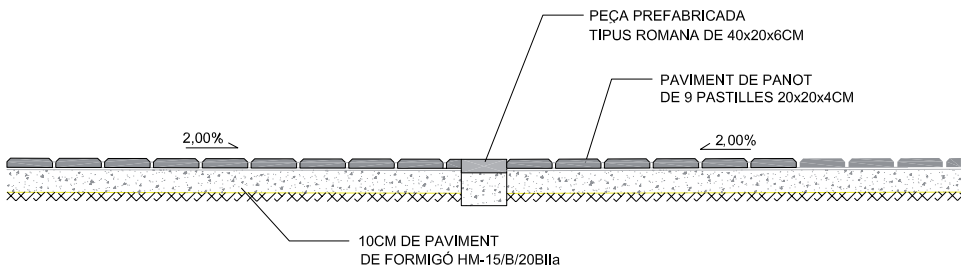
Detall d'un paquet de ferm de paviment de formigó
